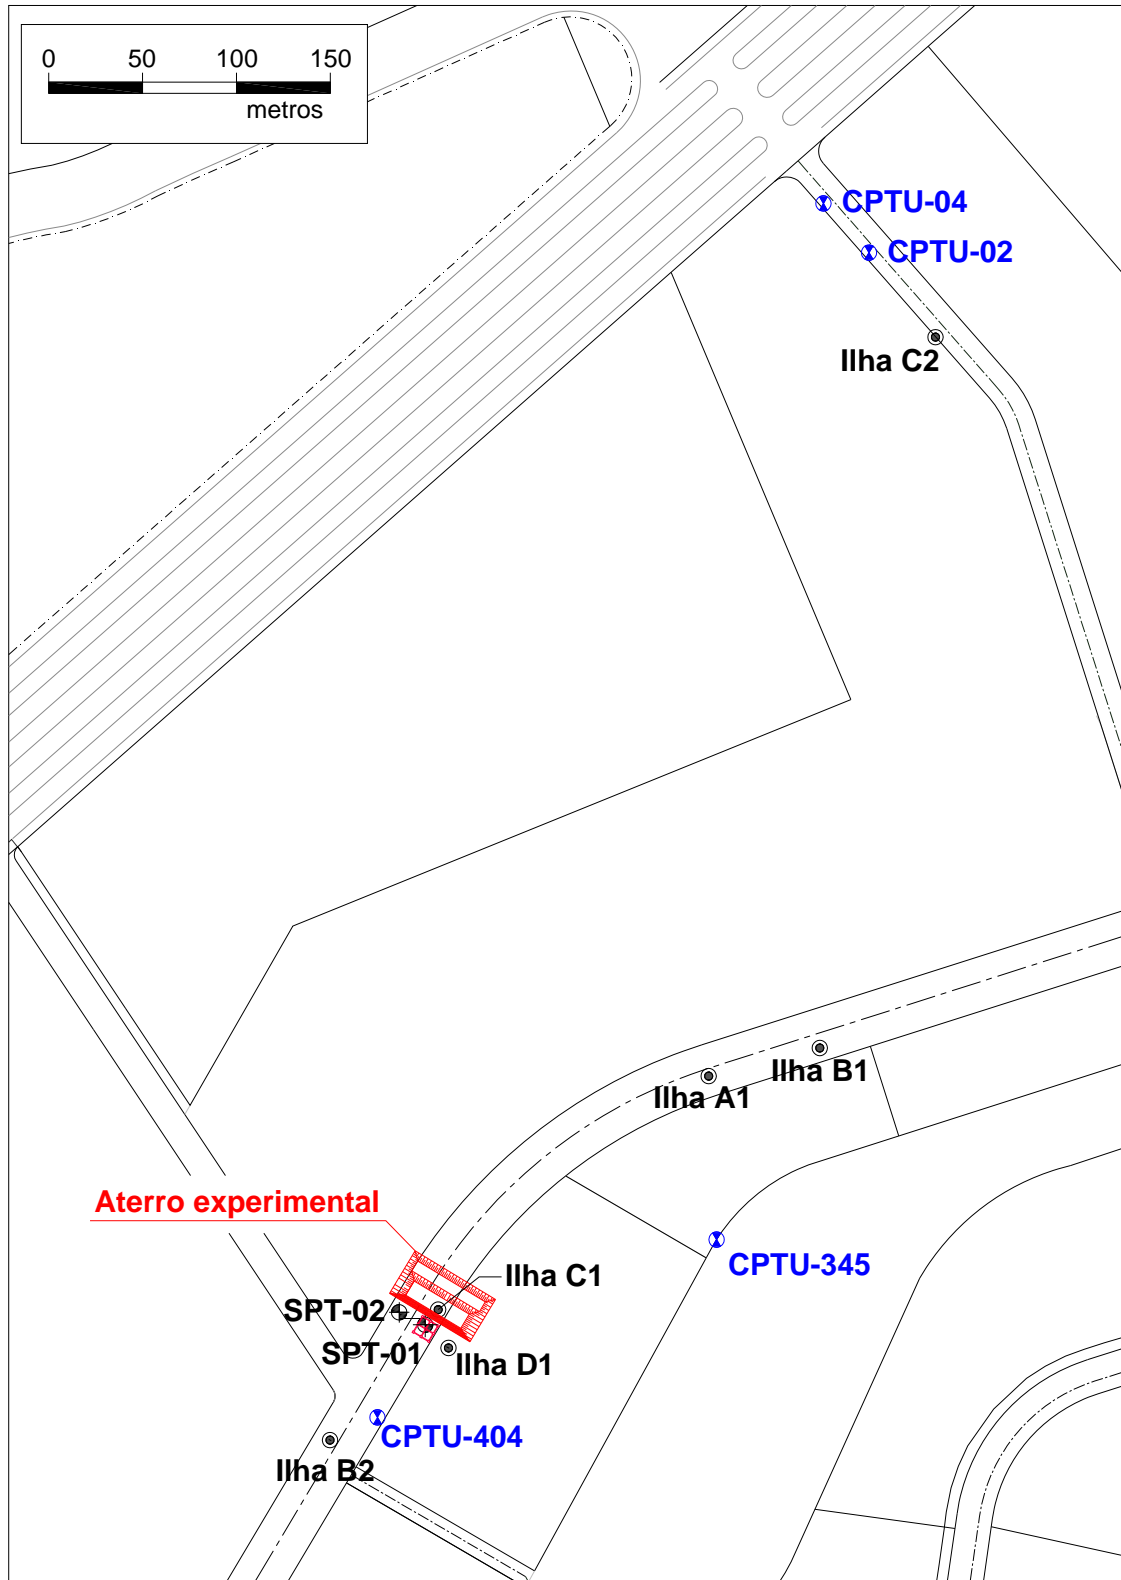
Locação em planta das investigações geotécnicas disponíveis sobre o layout das ruas internas da Vila dos Atletas
